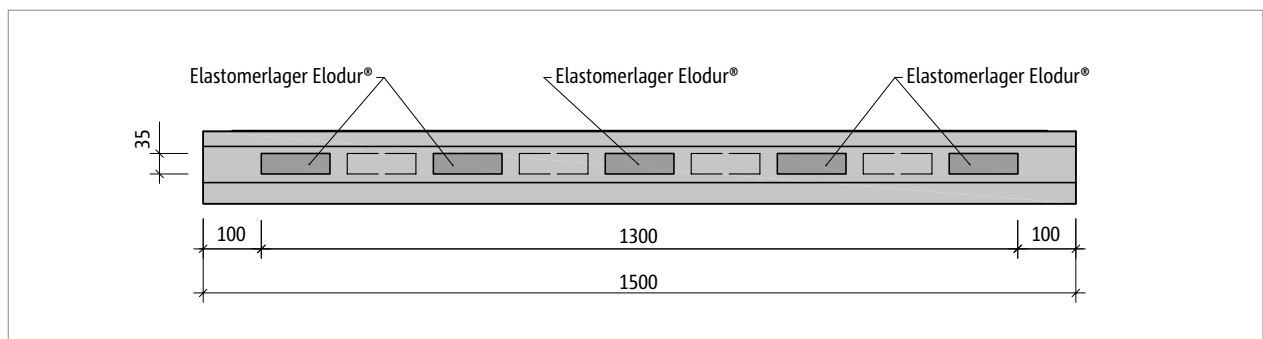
Schöck Tronsole® BL, BZ: Grundriss, beispielhafte Darstellung Tragstufe V1, Länge 1500 mm
